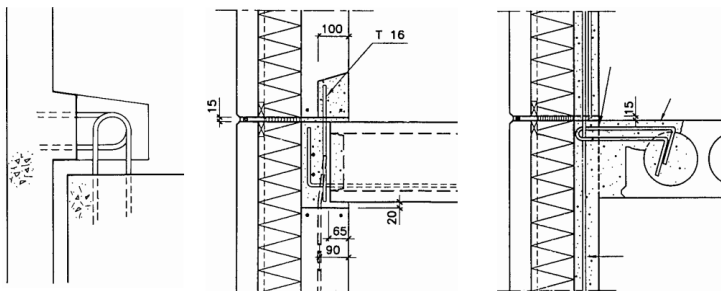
Exemplos de ligações com armaduras de sobreposição, com concreto de preenchimento no local. Fonte: Unicamp (S.D.).
